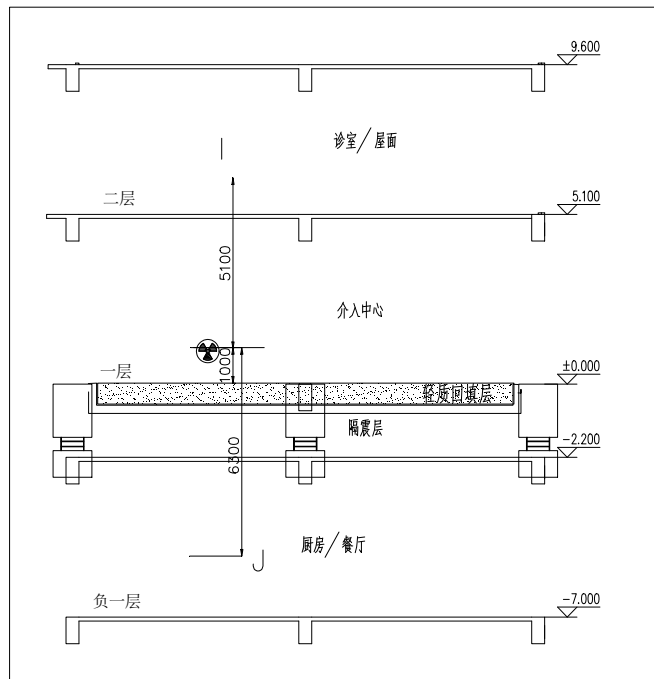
东门诊医技楼一层介入中心 DSA 机房估算点位图 (纵向)
